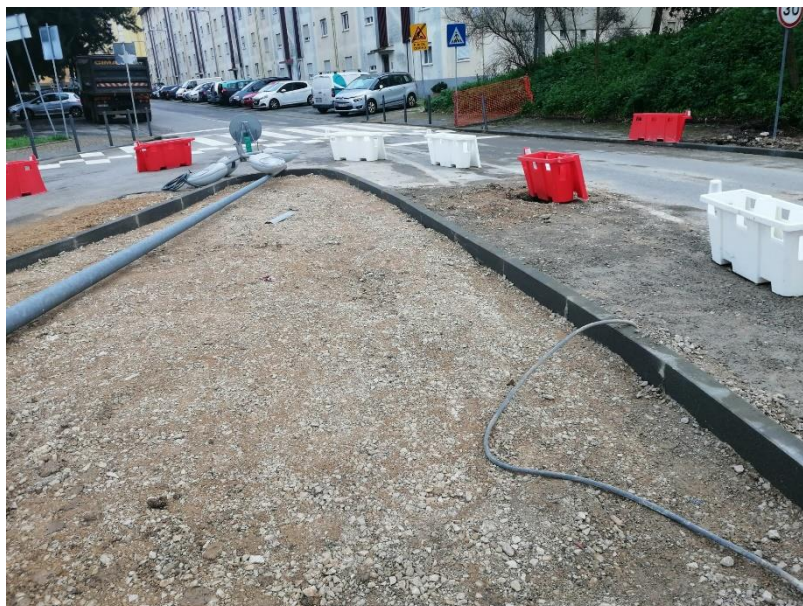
Remoção de poste de iluminação pública no Troço 5.
